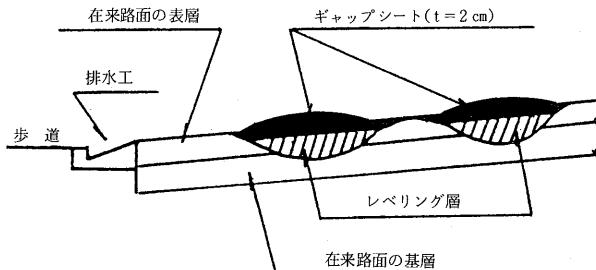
レベリング層のあるわだち掘れ埋戻し工法断面図
